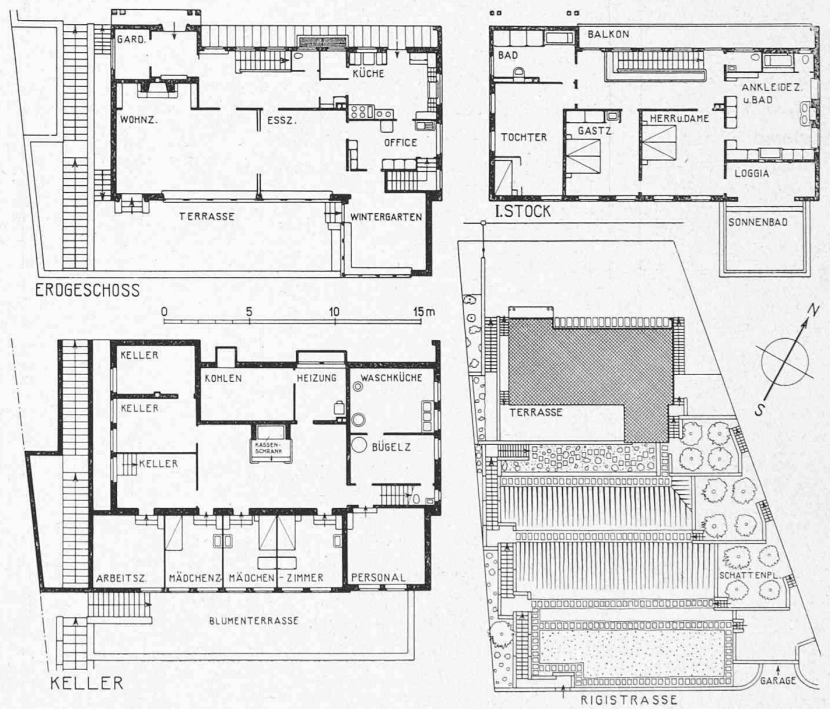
bis 4. Grundrisse 1 : 400; Lageplan 1 : 800.
